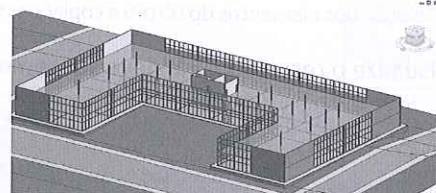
Vista da laje do Pav Tipo em 3D.
